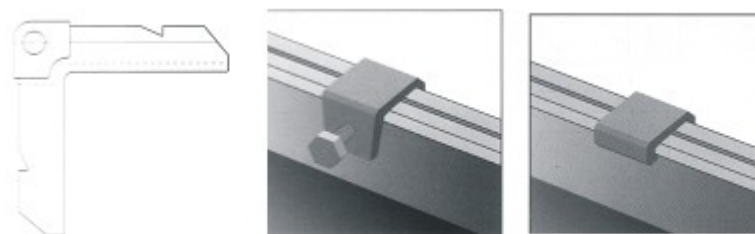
Элементы соединения прямоугольных воздуховодов, аналог фланцевому (угольник, стяжка накладок струбциной, установленная монтажная скоба)
